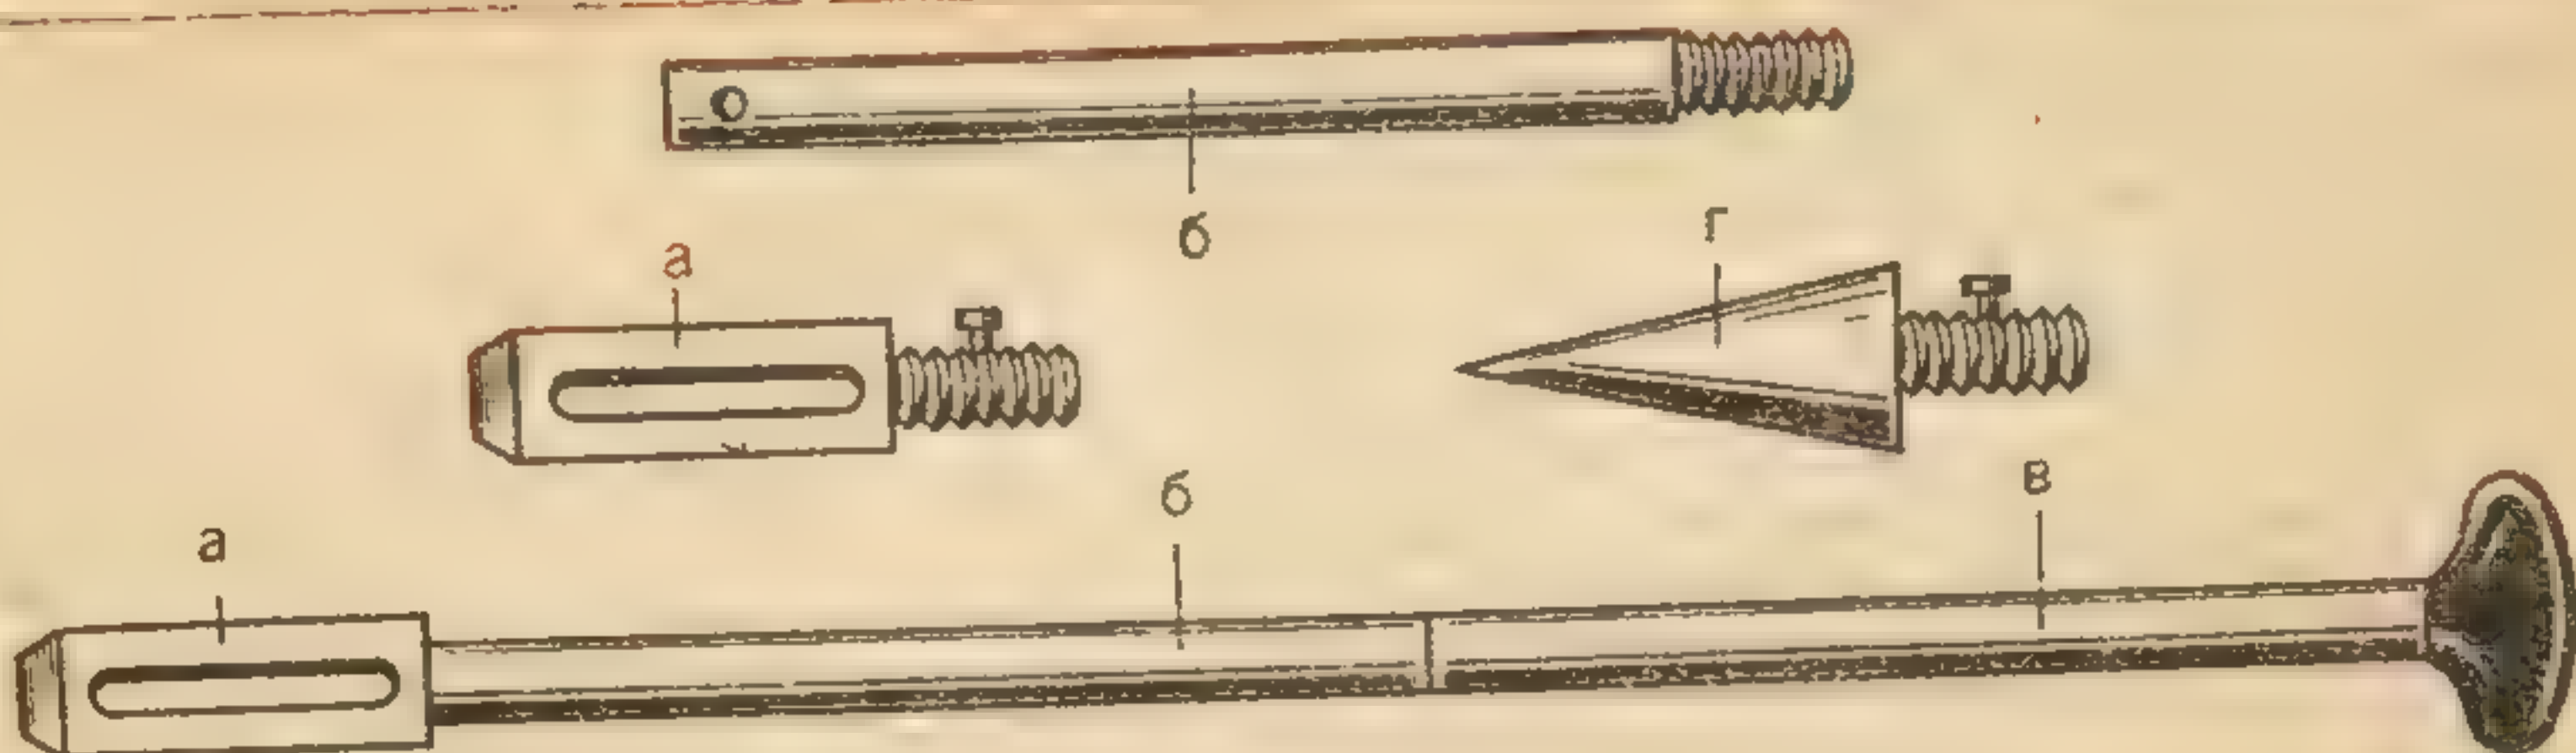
а — приспособление для взятия проб грунта; б — удлинительная штанга; в — рукоятка; г — конусный хвостовик
